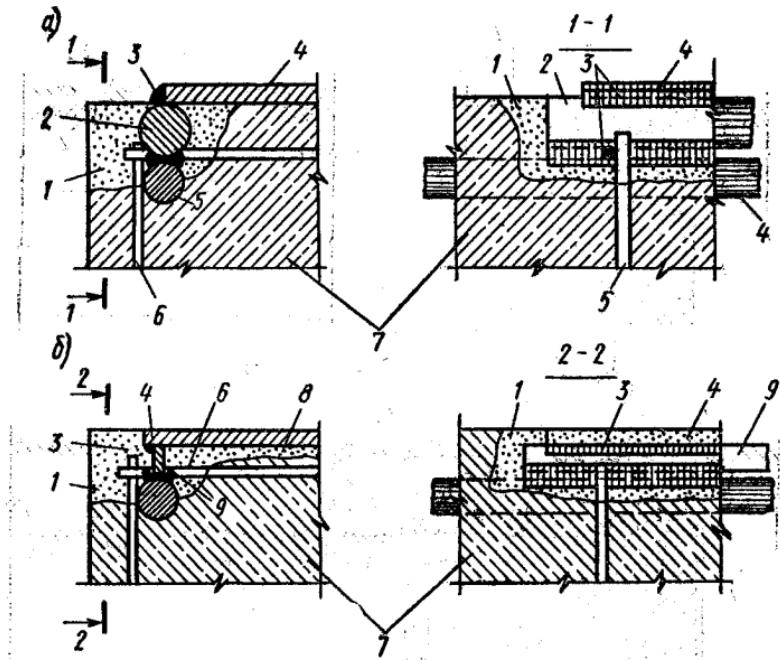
Установка дополнительных закладных деталей в железобетонных элементах:
